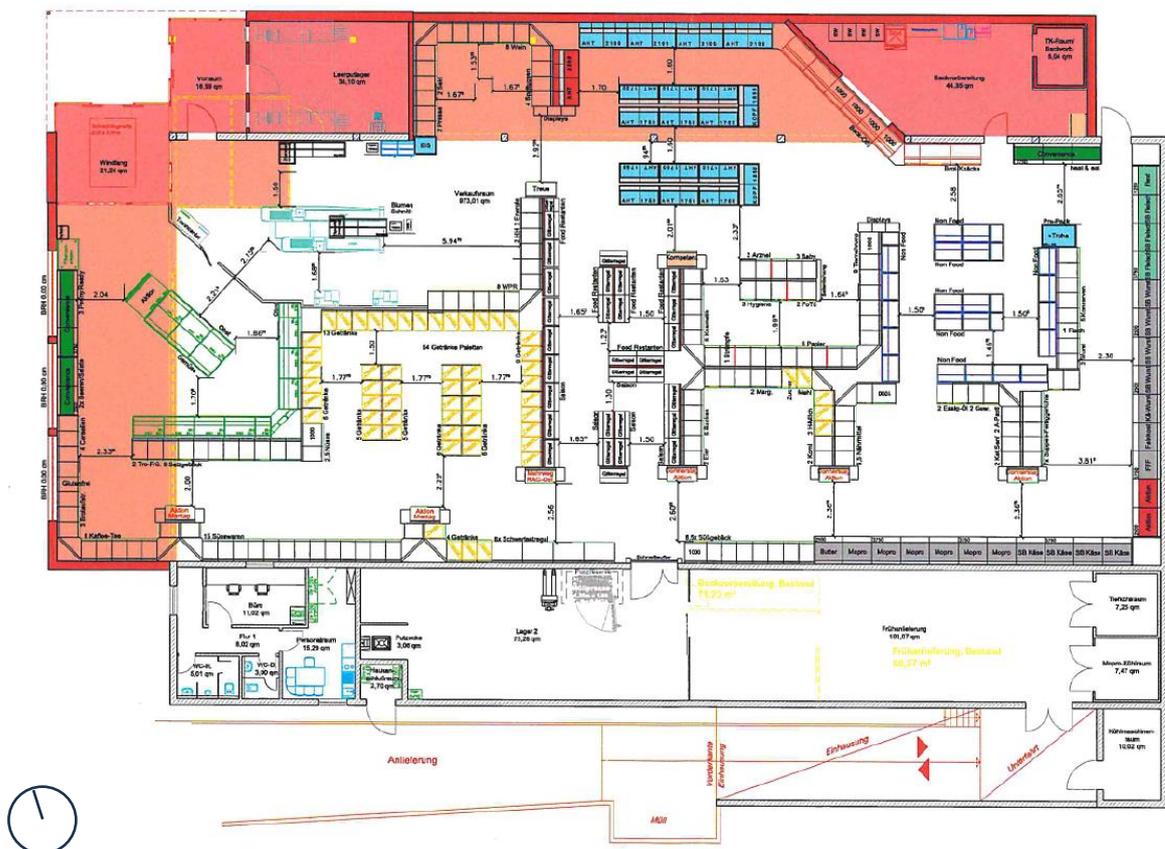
Bebauungs-/Umbaukonzept, Grundriss, freier Maßstab
